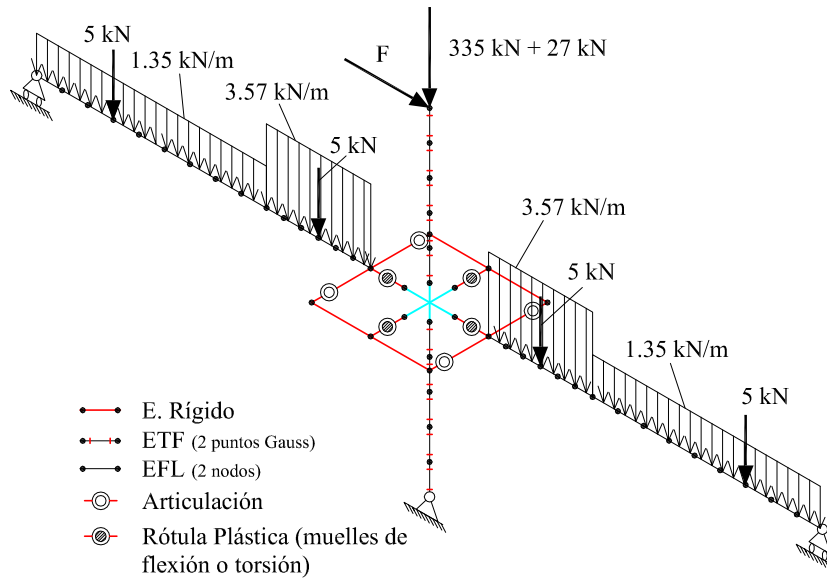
MEF del espécimen de la conexión interior pilar-forjado
